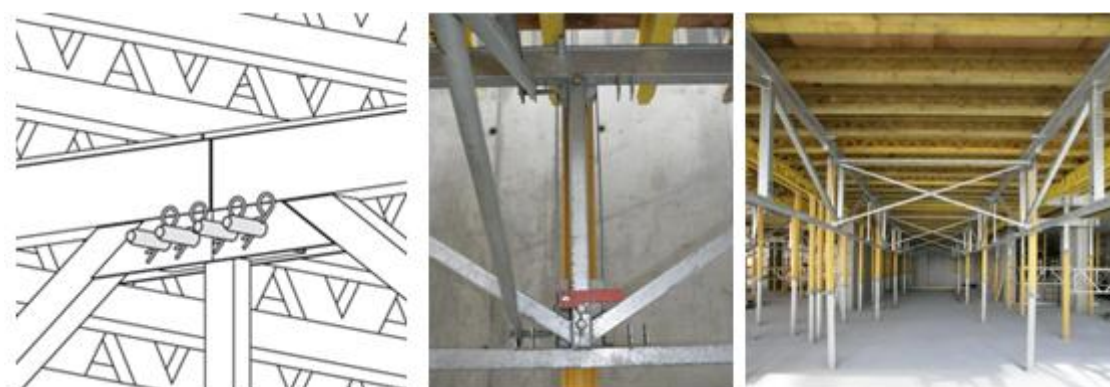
Ligação das vigas treliçadas com o pino simples e o contrapino, alavanca para o abaixamento da mesa e cofragem com altura de piso mais elevada (PERI s.d.).
